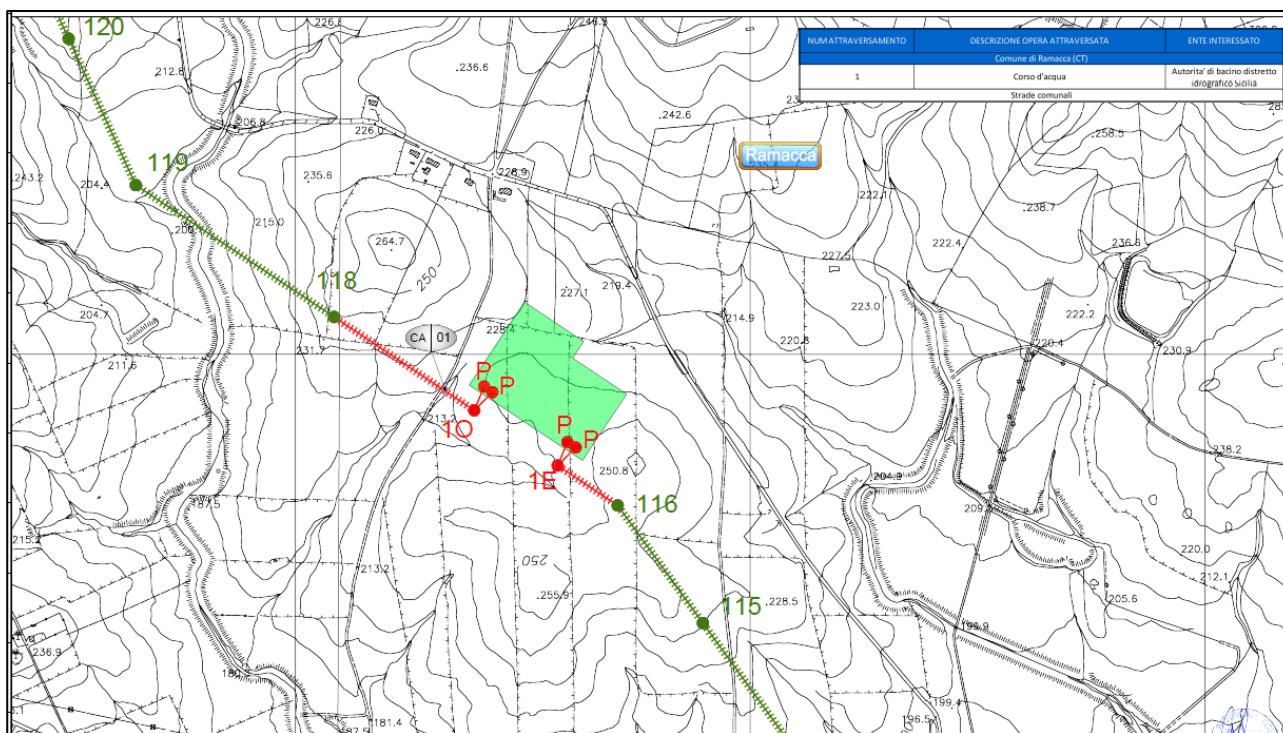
planimetria su CTR con indicazione delle opere attraversate
